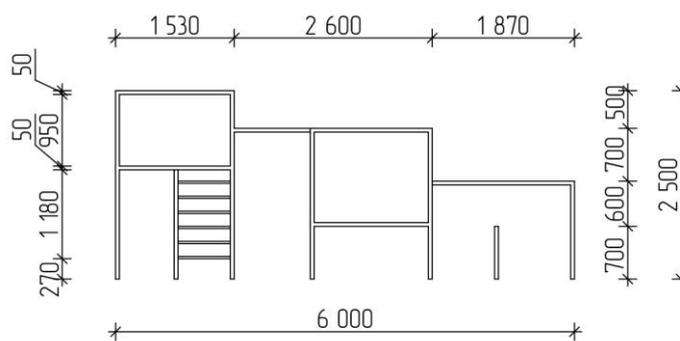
Чертеж разминочного лаза. Вид спереди
